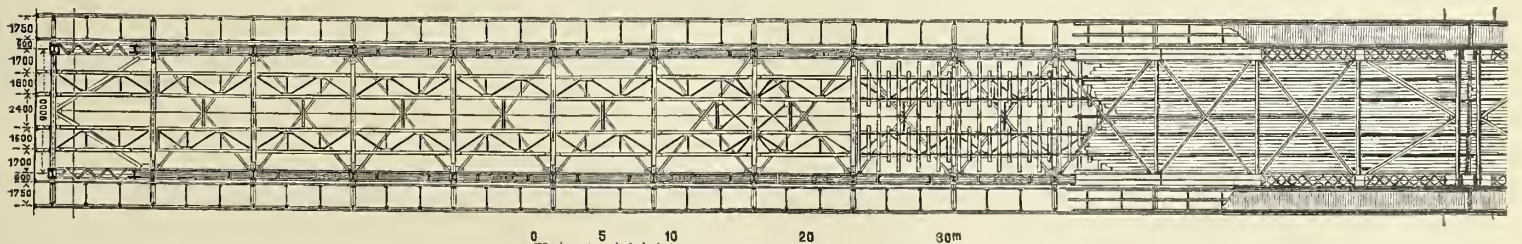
Grundriss und wagerechte Schnitte.
